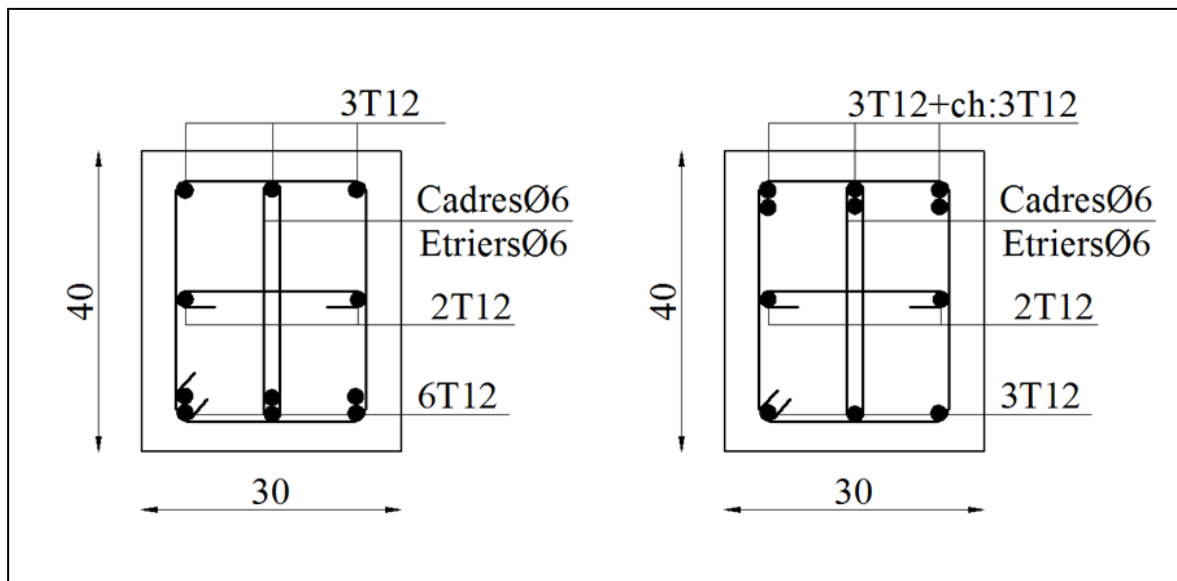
Dessin de ferrailage de poutre palier (appuis et travée).
